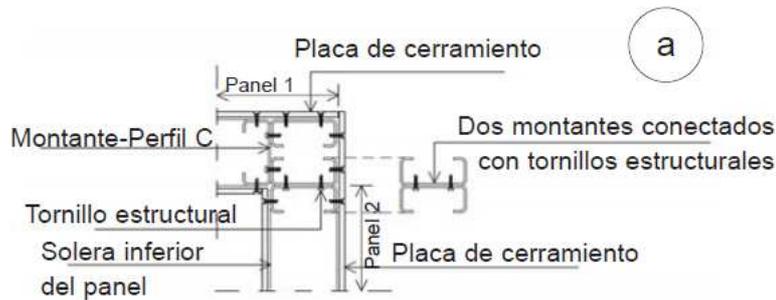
Detalle de unión entre muros; Fuente: Manual de Steel Framming
